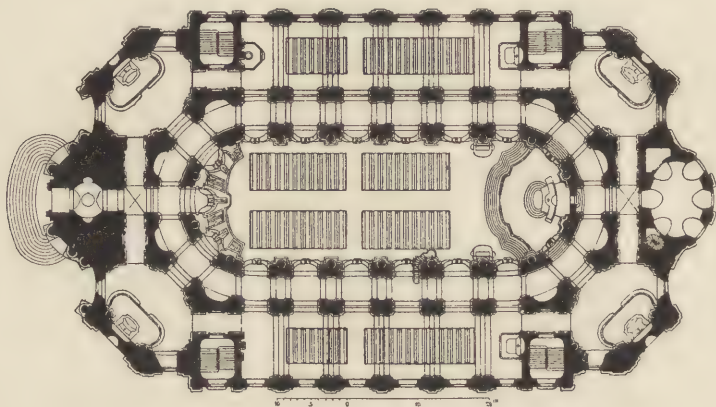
Katholische Kirche zu Dresden, Grundriss.
